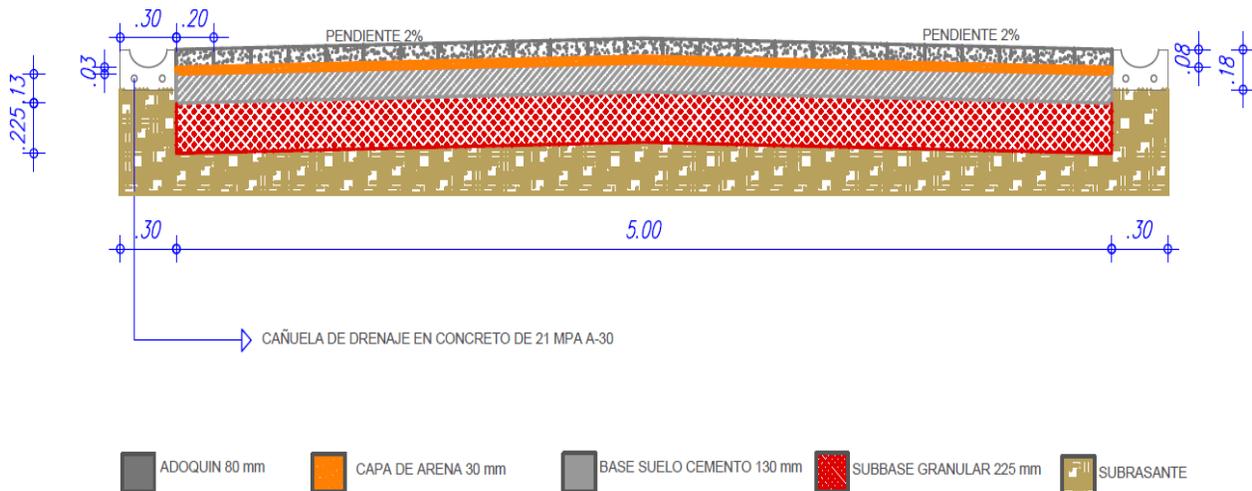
2: Estructura de pavimento articulado Método Británico. Tomado propio.
